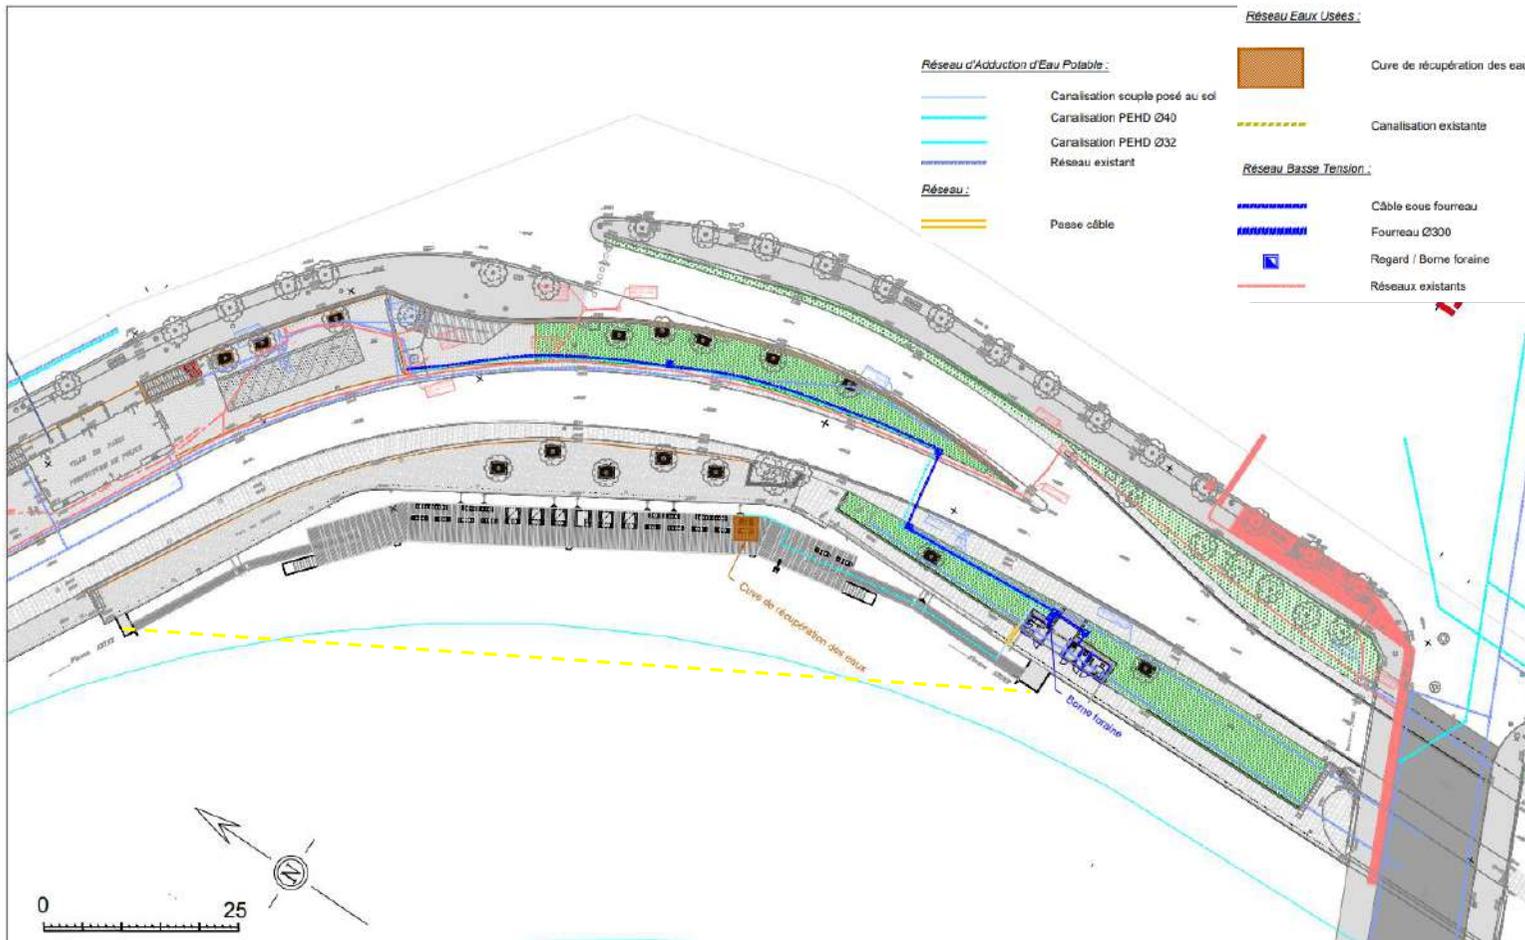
Plan de masse de l'installation et des réseaux afférents (Source : SOFID, 08/04/2024)
